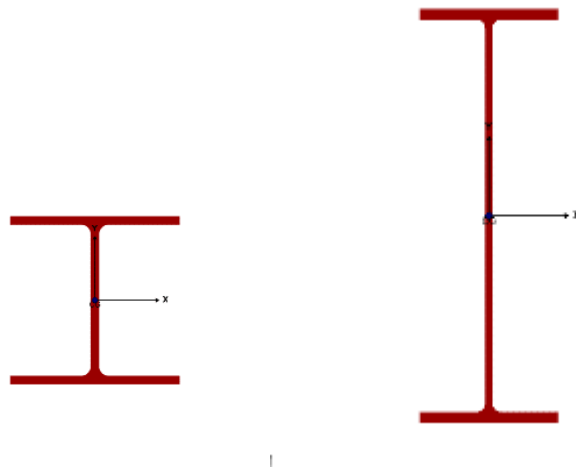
Coupes sectionnelles des poutres de 57' (gauche) et 23' de long (droite)
